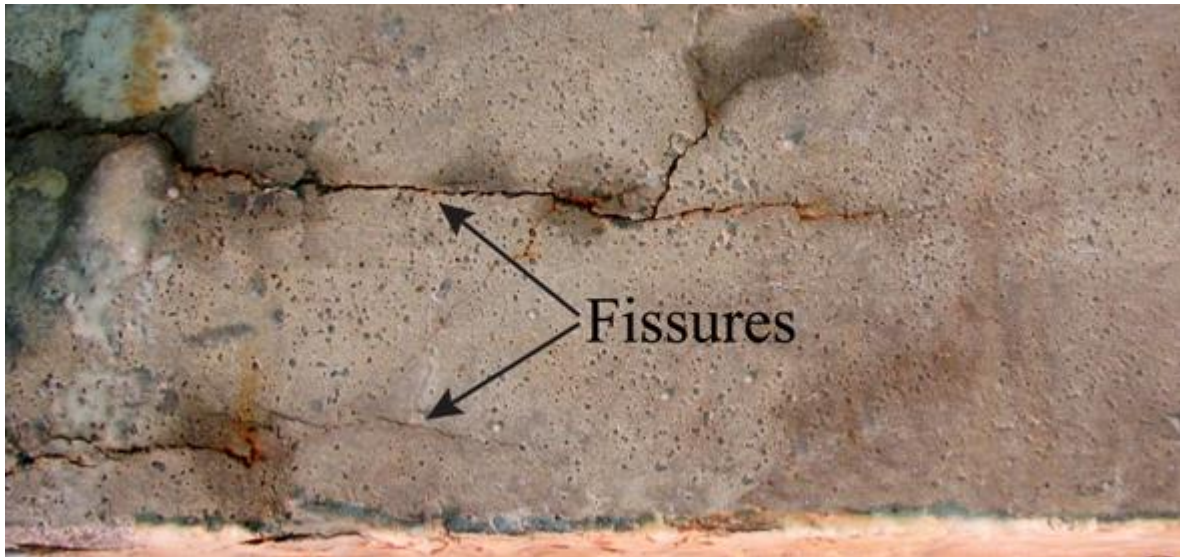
1 : Fissuration causée par la corrosion des armatures
